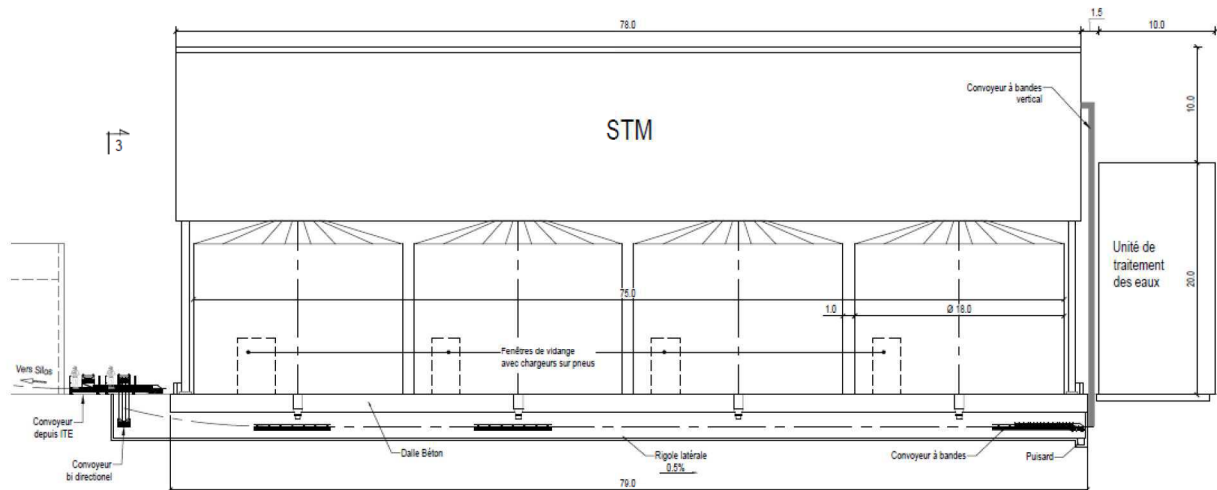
Vue en coupe de la STM (ALLTI, avril 2021)
